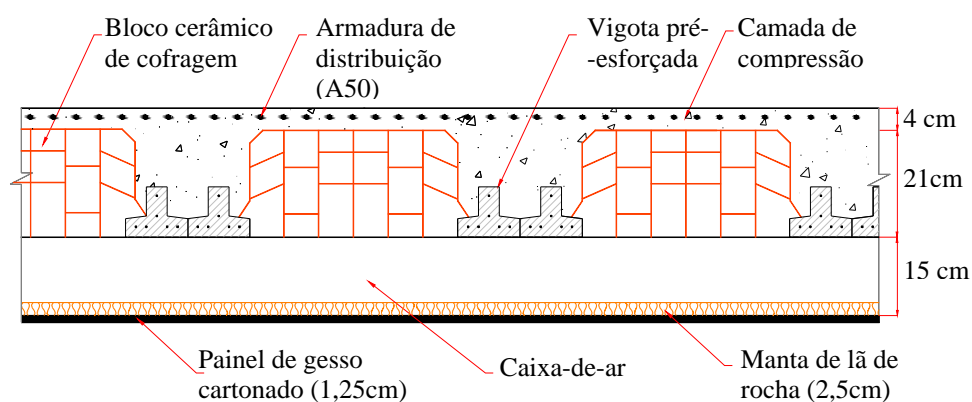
Pavimento aligeirado de vigotas pré-esforçadas e blocos cerâmicos de cofragem, com tecto falso e isolante no tardo (Pav2)
